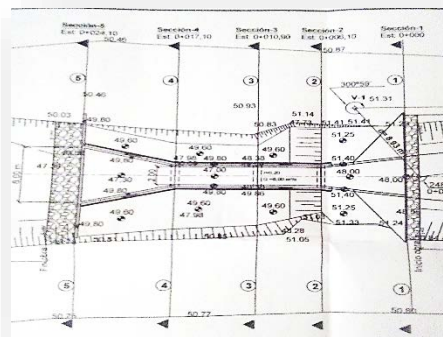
Vista en planta de la obra de fábrica según proyecto, 2007. Fuente: Archivo DPRH Granma, 2020
